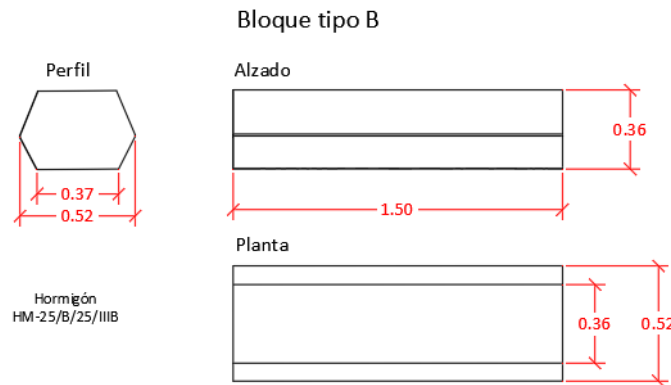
Dimensiones Bloque de hormigón TIPO B.
